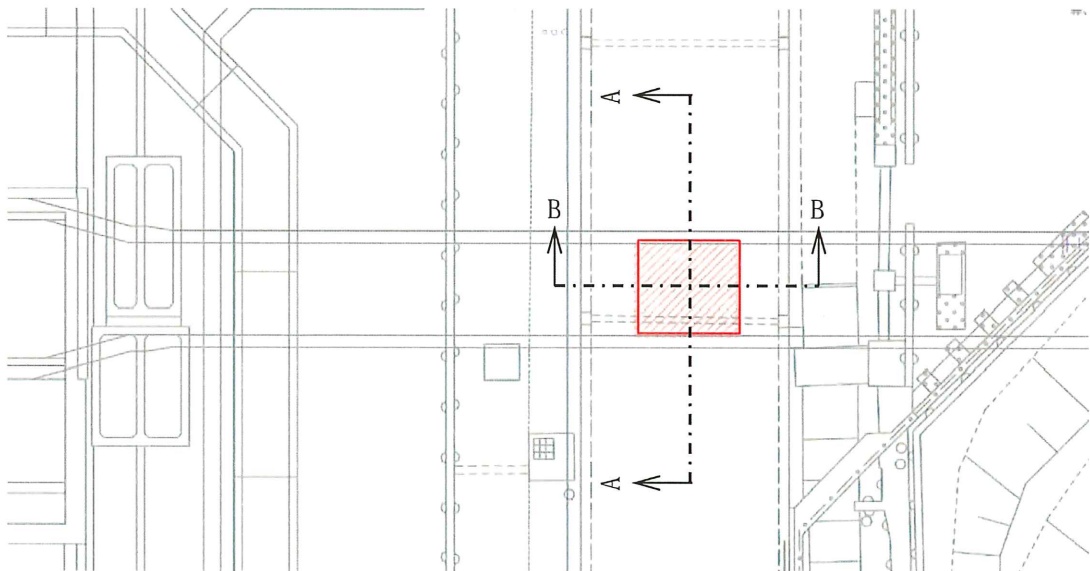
(1) 取放水路流路縮小工（第1号機放水路） 平面図
